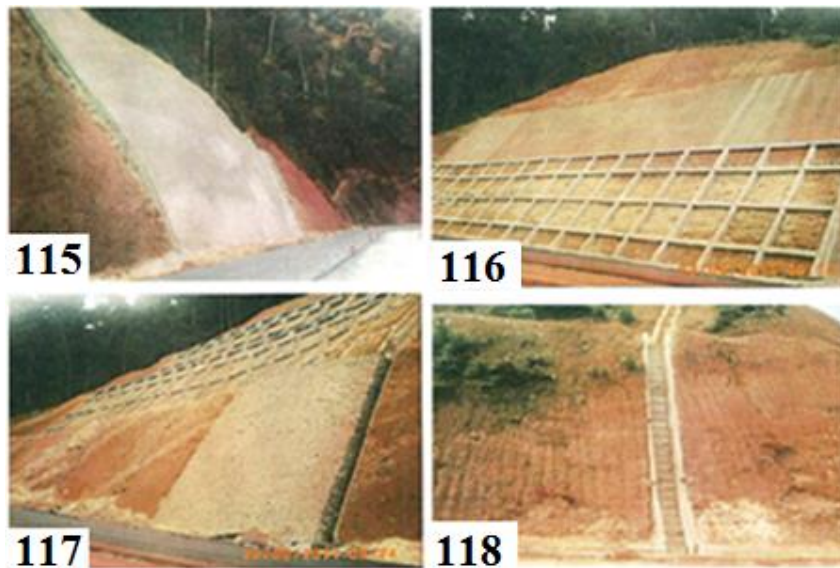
Talus stabilisé par la technique de béton ; Photos 116 et 117 : Talus Stabilisés par la méthode du béton projeté et la méthode d'armement du sol par des poutrelles ; Photo 118 : Caniveau en petite terrasse.
